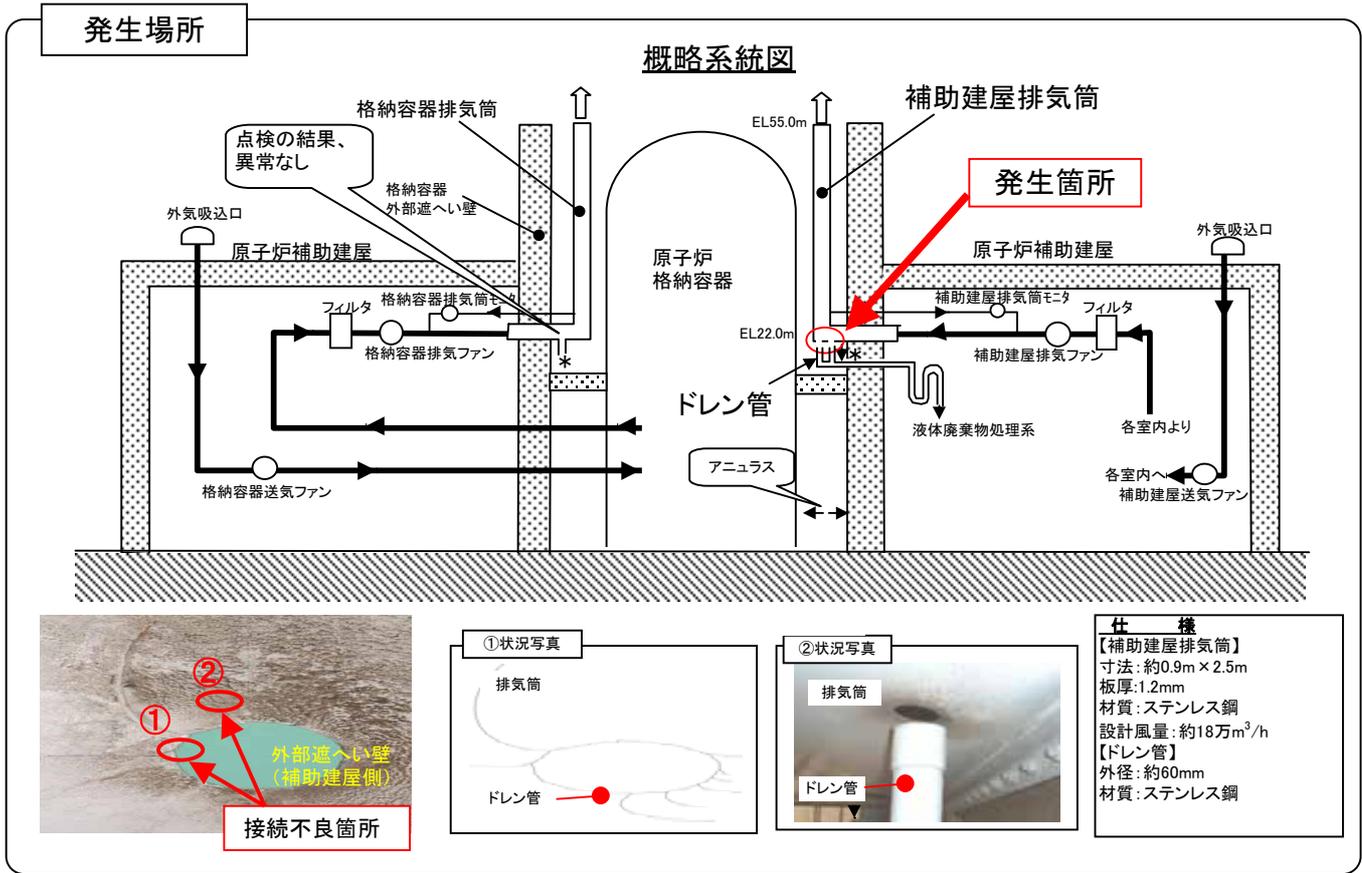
(1) 補助建屋排気筒のひび割れおよびドレン管の接続不良の原因と対策について
